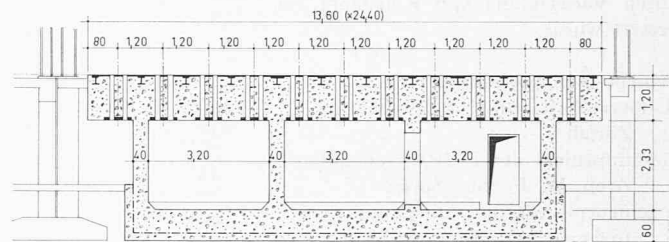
Querschnitt 1:200 durch den Aufspannboden, Hohlkasten aus Eisenbeton, vom übrigen Gebäude abgetrennt. Bodenplatte als Wanne (Grundwasser). Die Hohlräume werden als Luftschutzräume verwendet. Grundplatte 1,2 m stark mit 220 Ankerstellen
